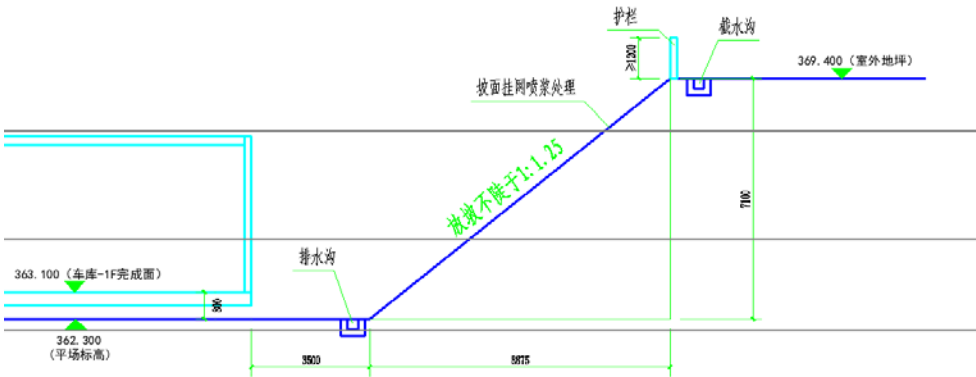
地下车库基坑边坡坡率法剖面图（2-2剖面）
